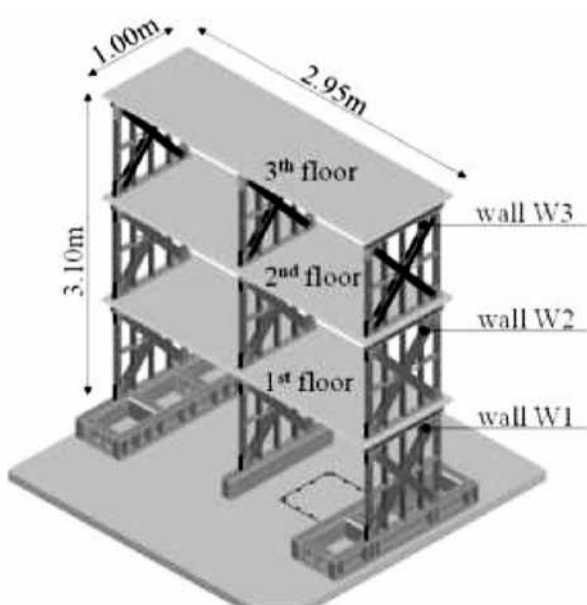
Полномасштабные испытания экспериментального образца LAMIEREDIL [32]
